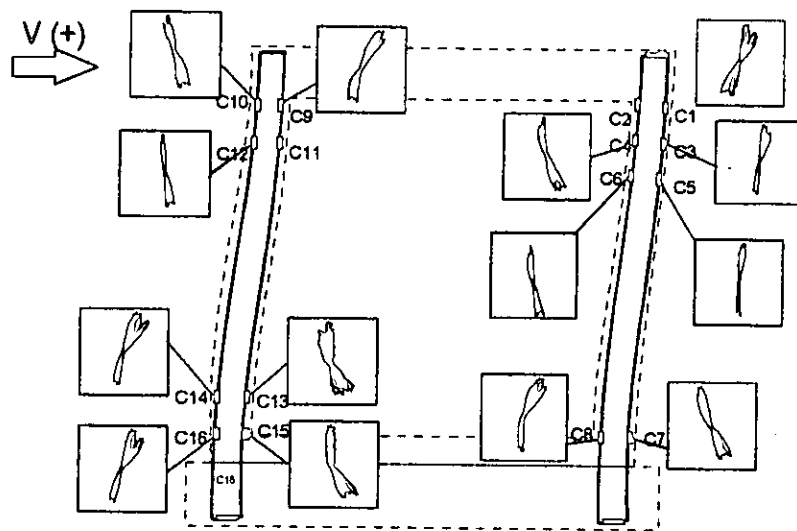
Deformación esquemática en las columnas del espécimen TO deducida de los deformímetros
